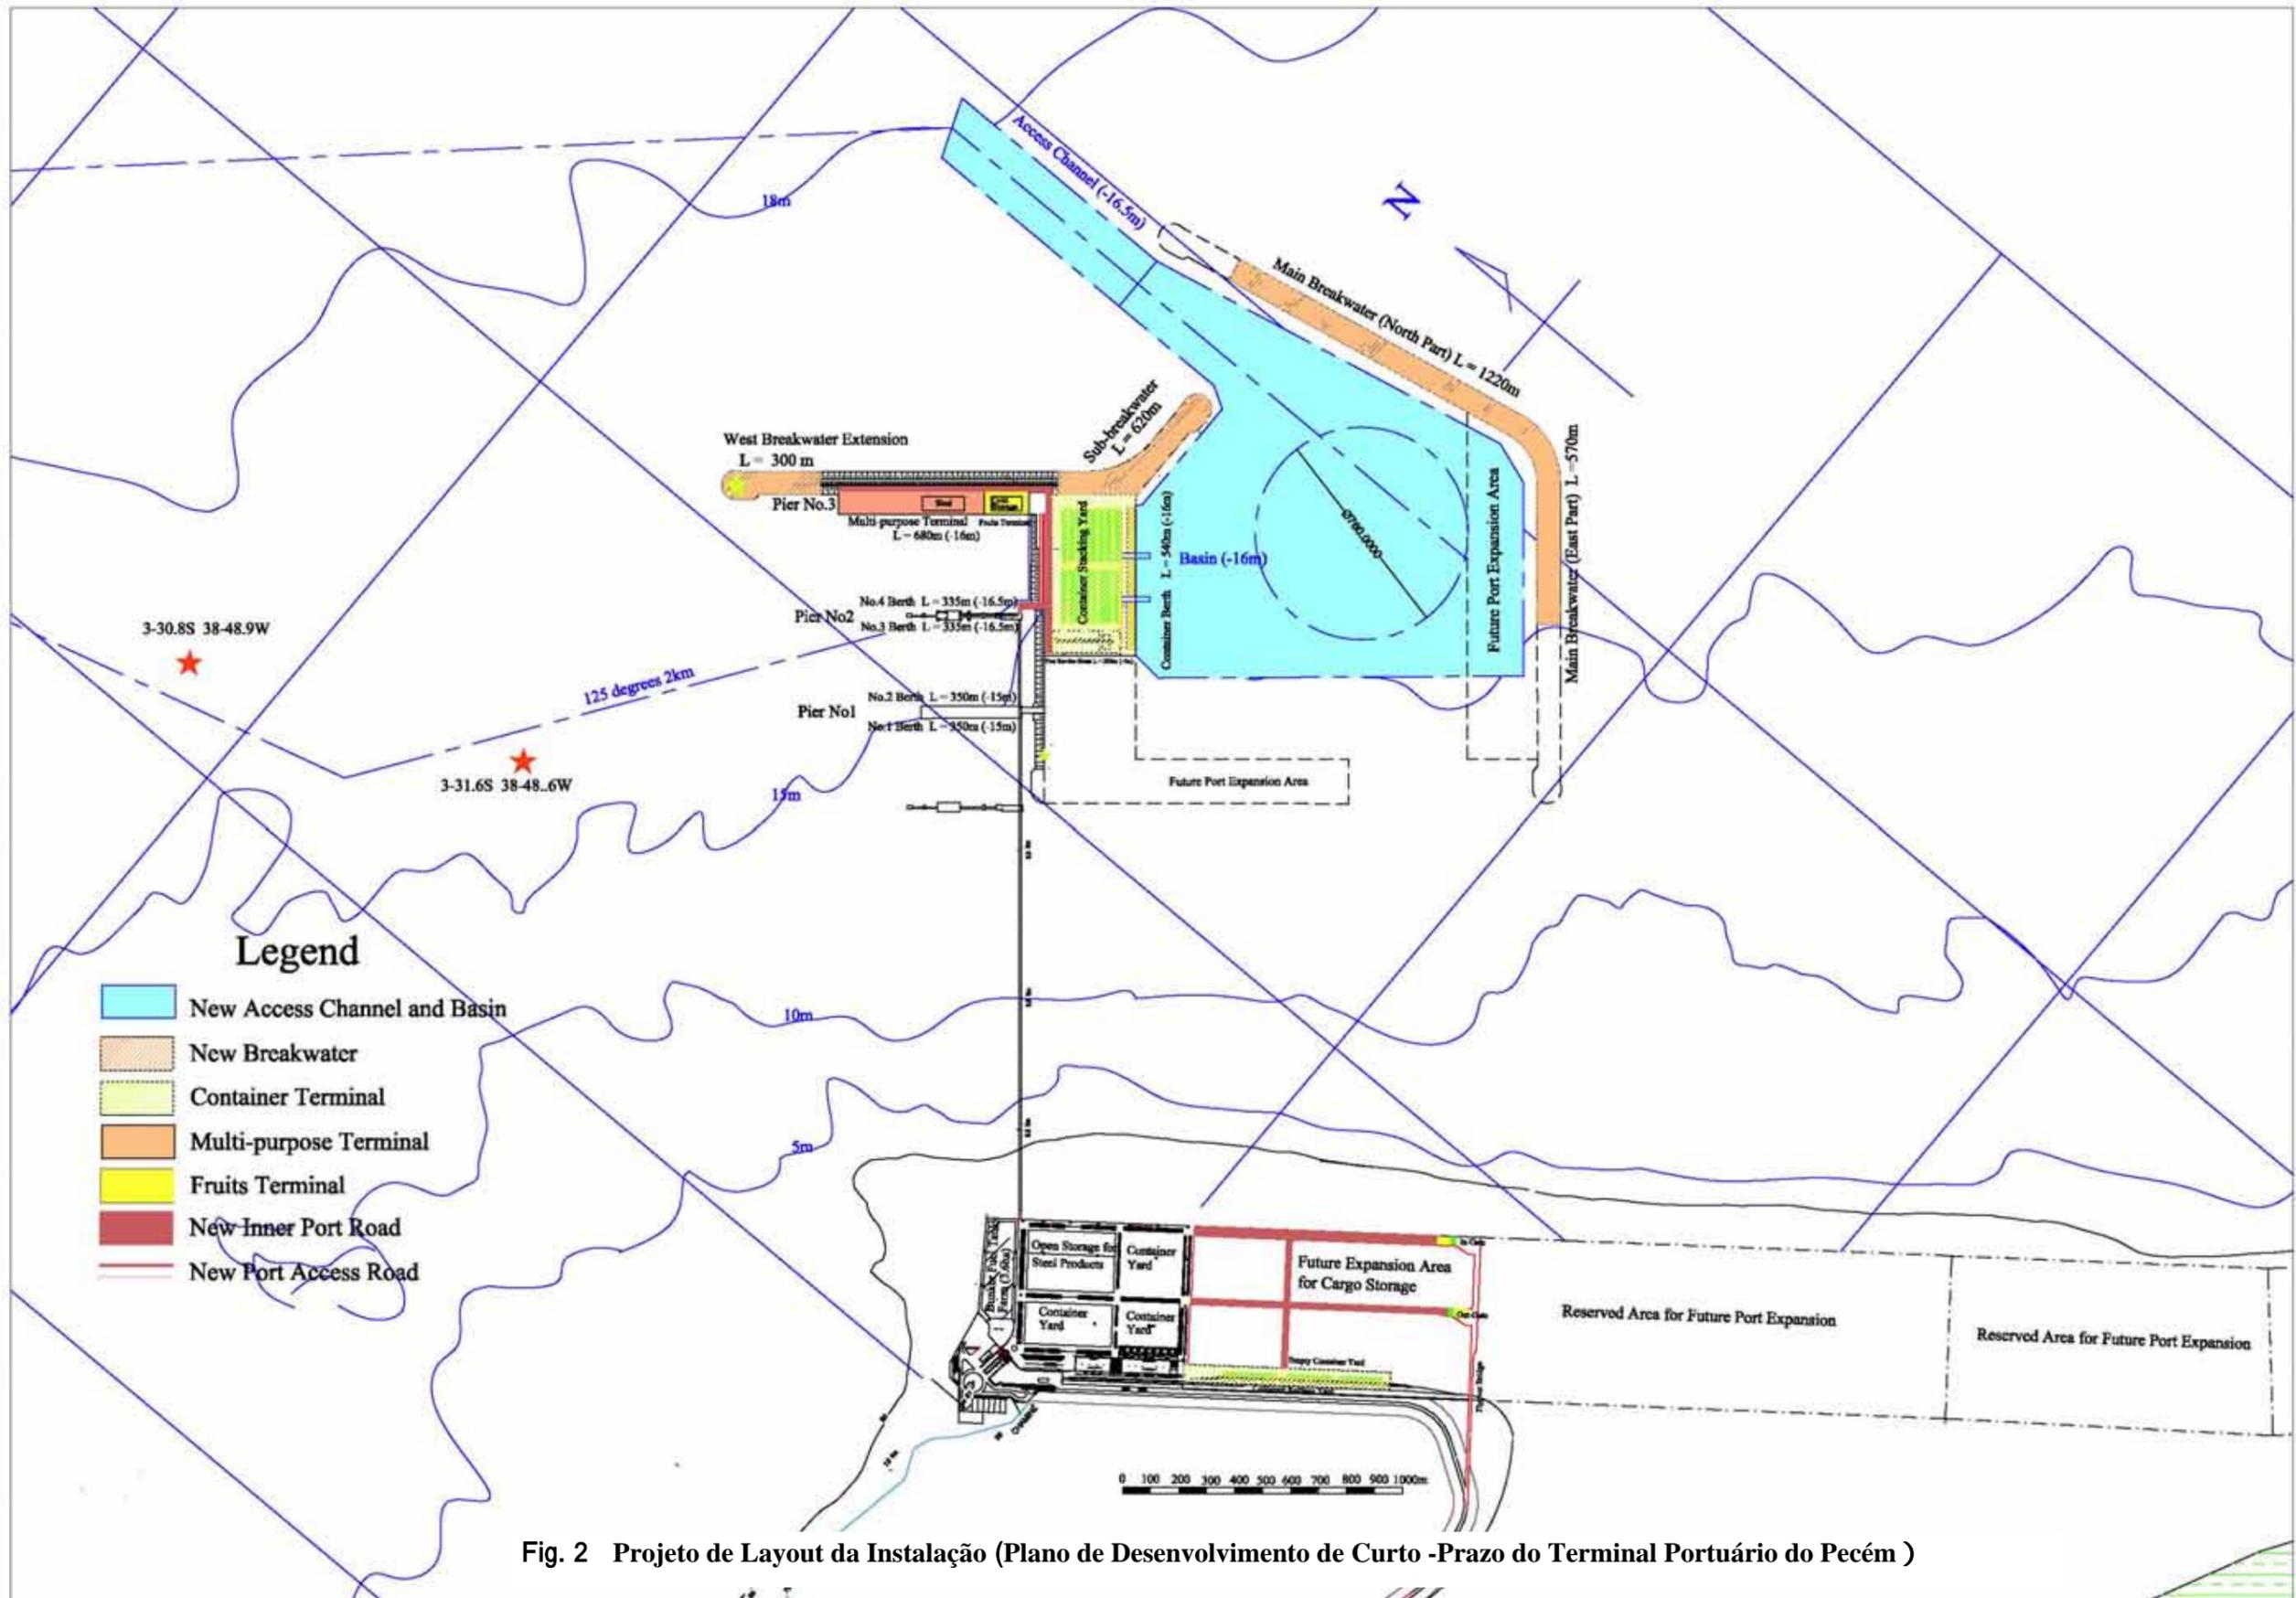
Projeto de Layout da Instalação (Plano de Desenvolvimento de Curto -Prazo do Terminal Portuário do Pecém)
